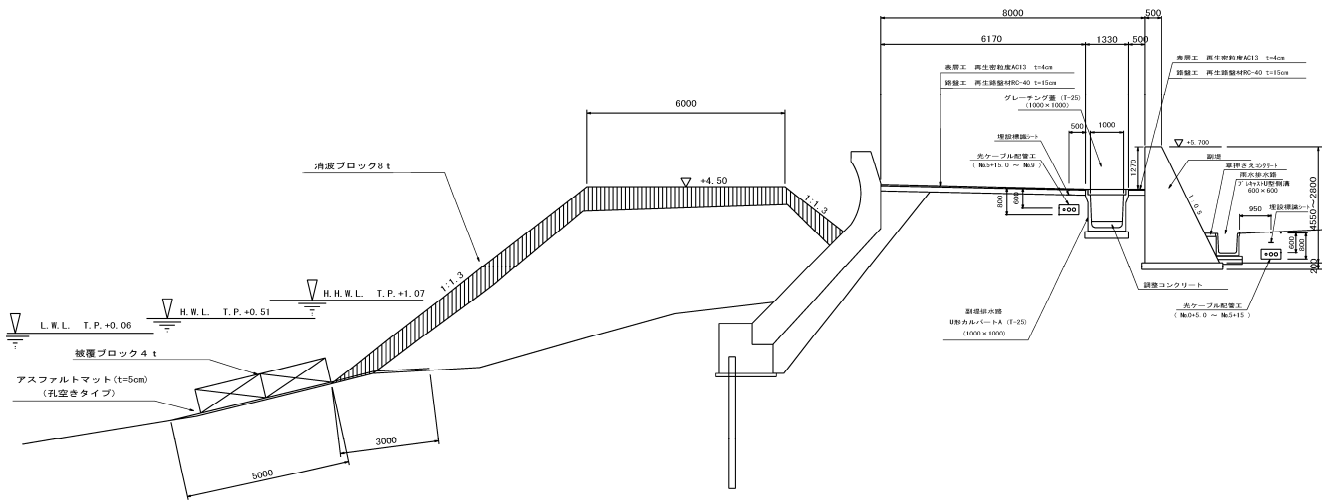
施工事例 副堤標準断面図（下新川海岸・生地）
